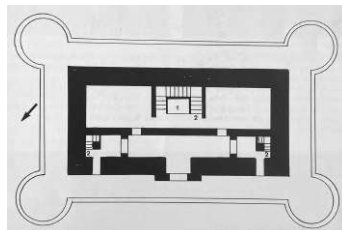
Untere Plattform Grundrisse Leittürme. Größen im Verhältnis zueinander.
